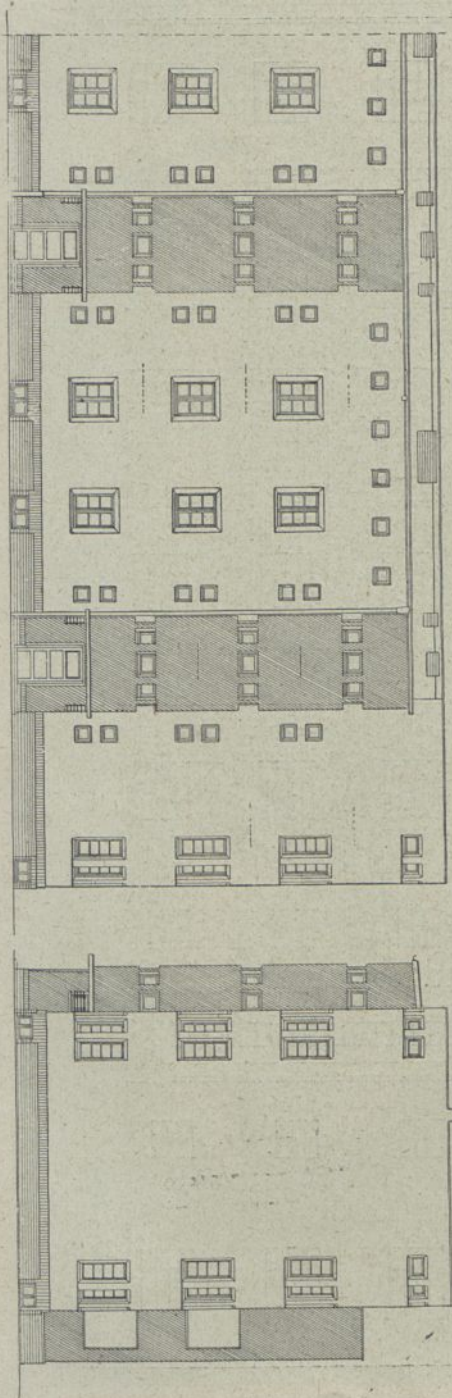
Großsiedlung Briz. Grundriß eines Sechsfamilienhauses Typ. II. Verfasser: Bruno Taut.
